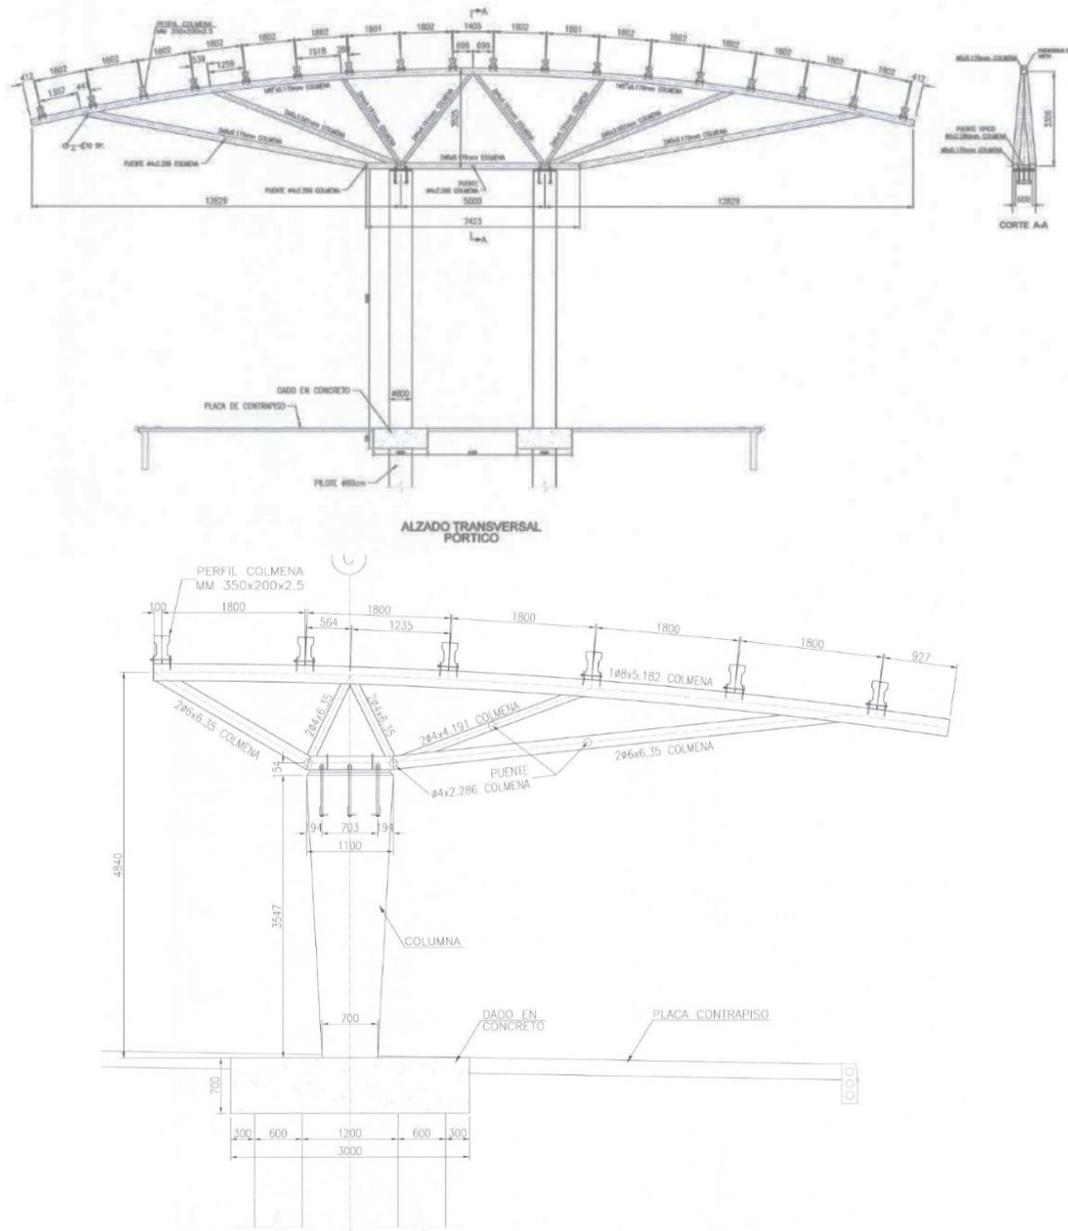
Alzado de cubierta metálica de articulados y alimentadores.
